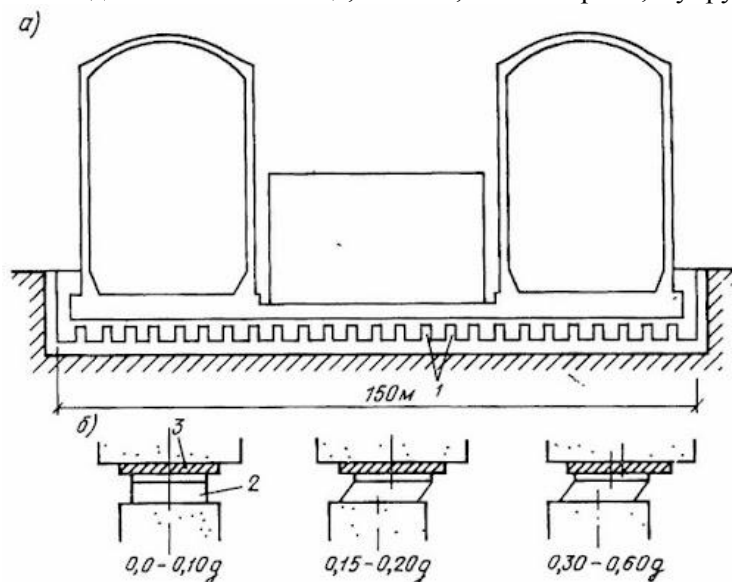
Сейсмоизоляция атомной станции «Коеберг»: *a* – конструктивная схема; *б* – схема работы фрикционной опоры при различных нагрузках; 1 – фрикционные фундаментные опоры; 2 – упругая подушка из армированного неопрена; 3 – фрикционные пластины
